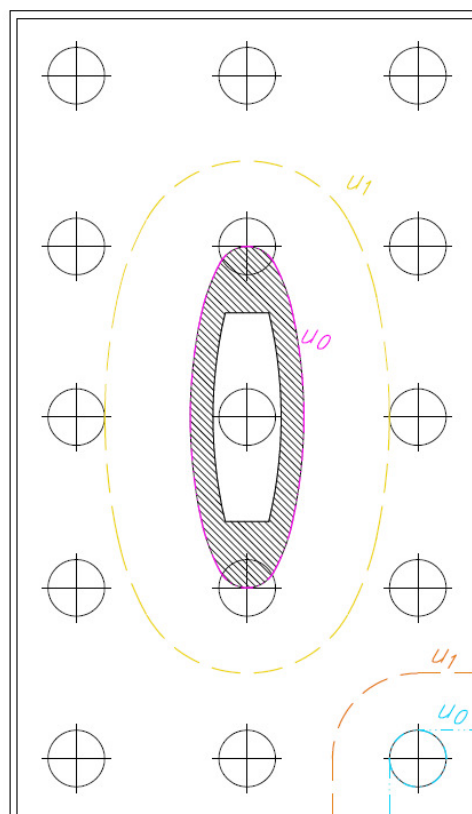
Illustrazione schematica dei perimetri di verifica a punzonamento considerati per il palo d'angolo e la pila.
